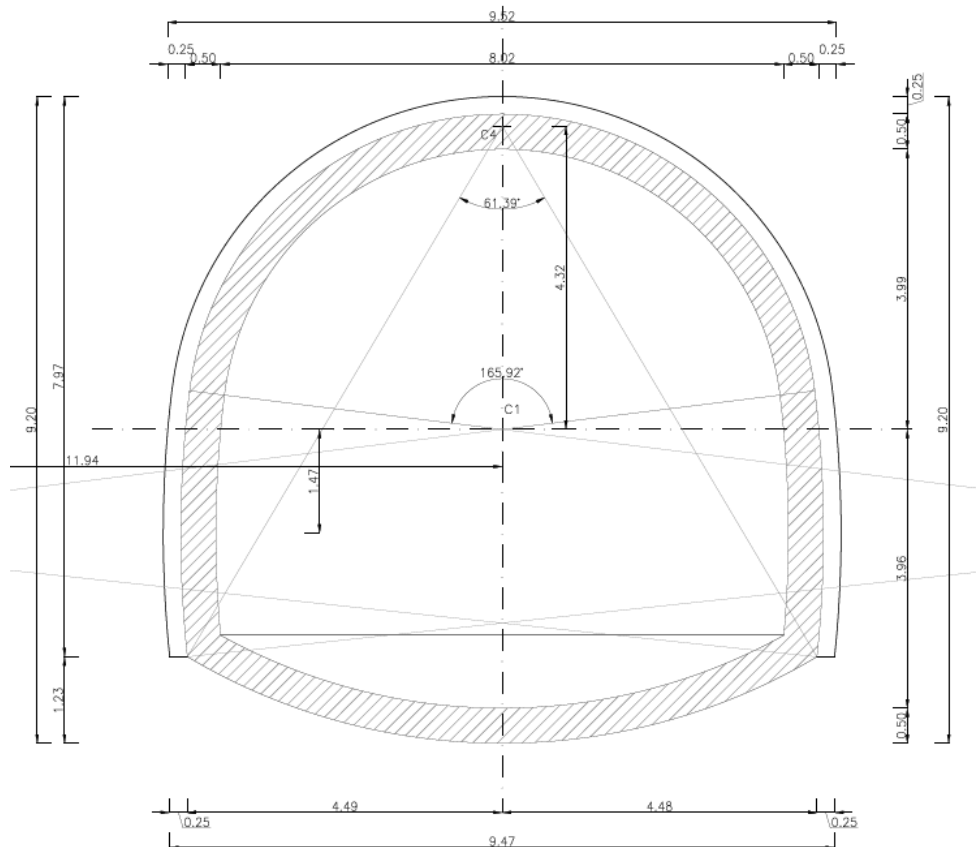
Sezione tipo della galleria di accesso al pozzo piezometrico
